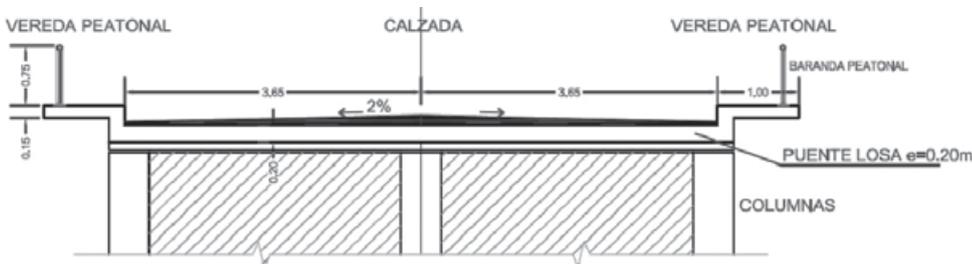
Sección tipo de puente de cruce del canal de drenaje.
